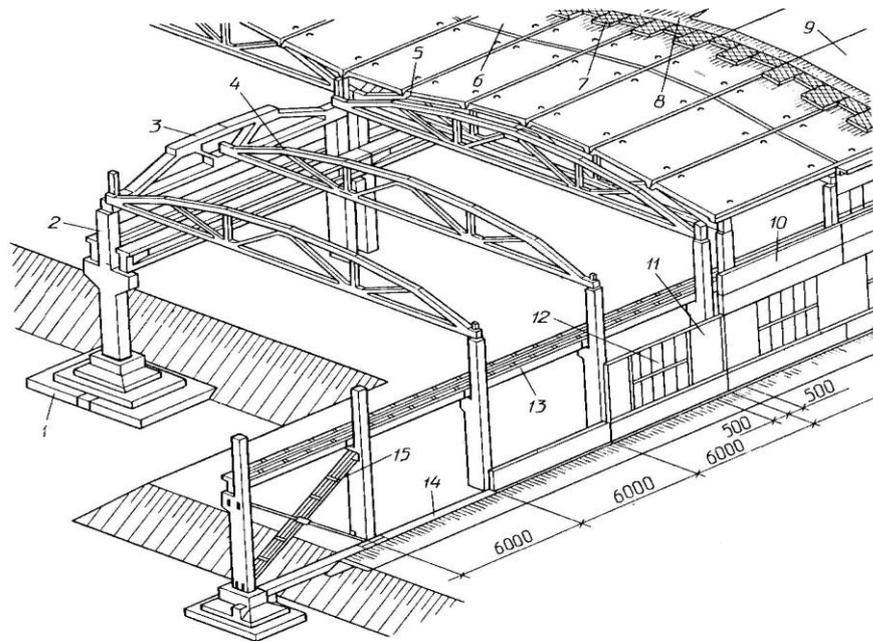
Железобетонный каркас одноэтажного промздания со стропильными и подстропильными фермами:
